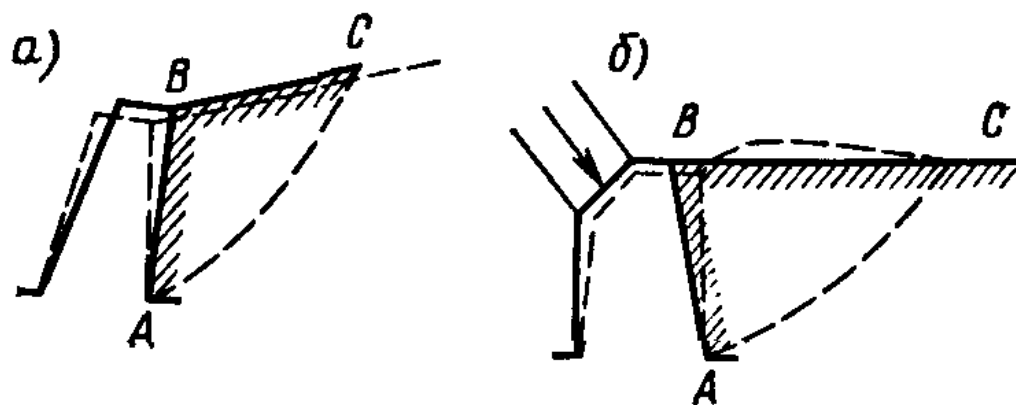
Схемы давлений грунта на подпорную стенку:
